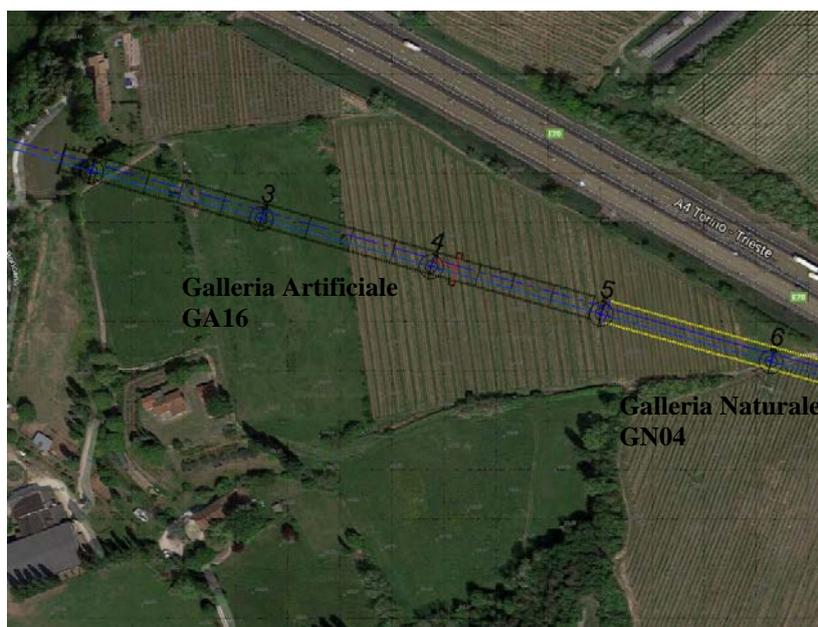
Stralcio planimetrico con ubicazione delle opere.
